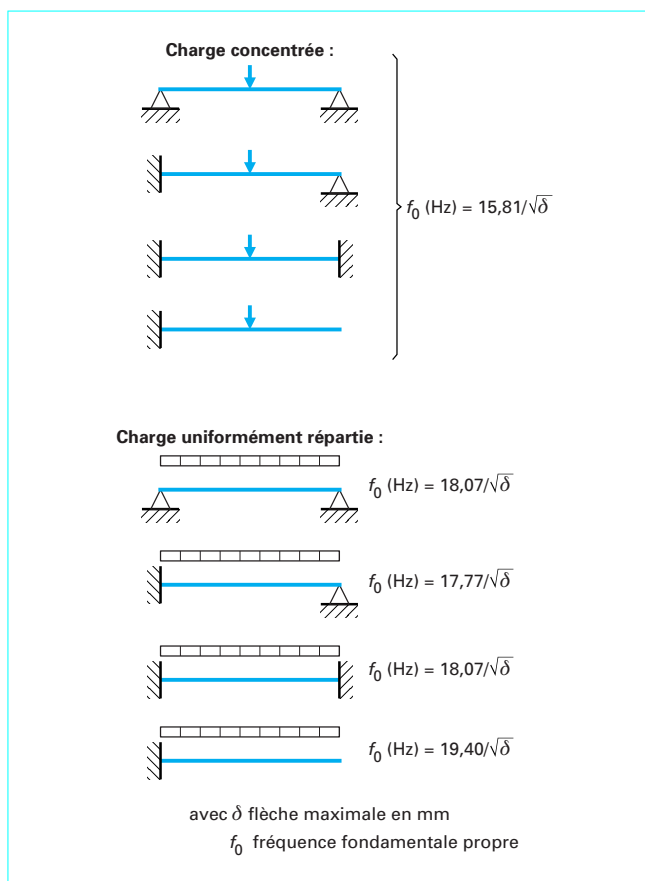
Fréquence fondamentale propre de poutres de plancher
